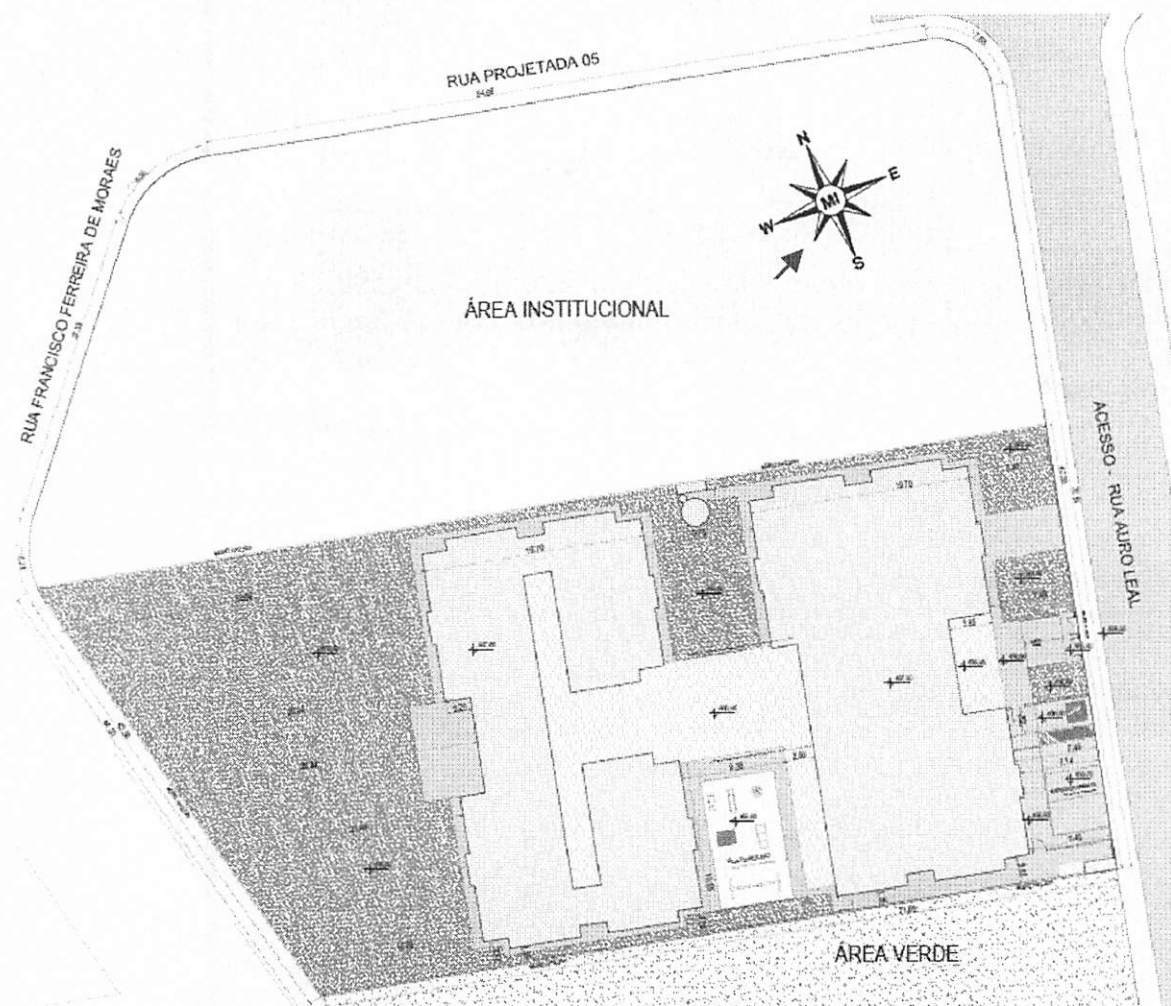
Planta de locação da obra no terreno. Exemplo Creche Pré-Escola
